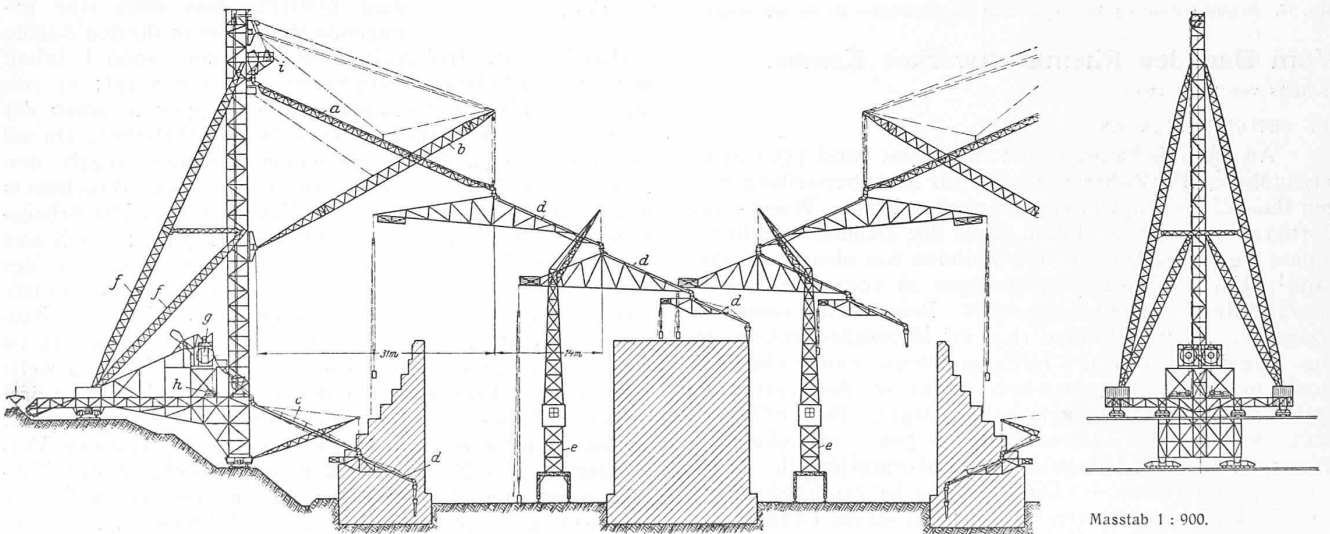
Fahrbare Gussbeton-Anlage auf der Schleusen-Baustelle des Kraftwerkes Kembs. — Bauzustand 17. Mai 1930.
